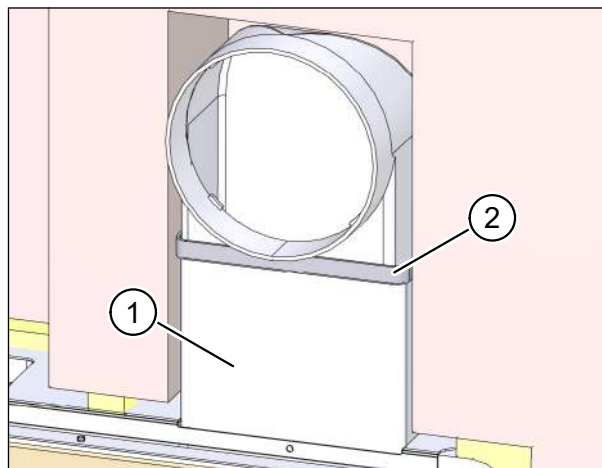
Fissaggio degli allacciamenti del canale piatto con nastro sigillante
